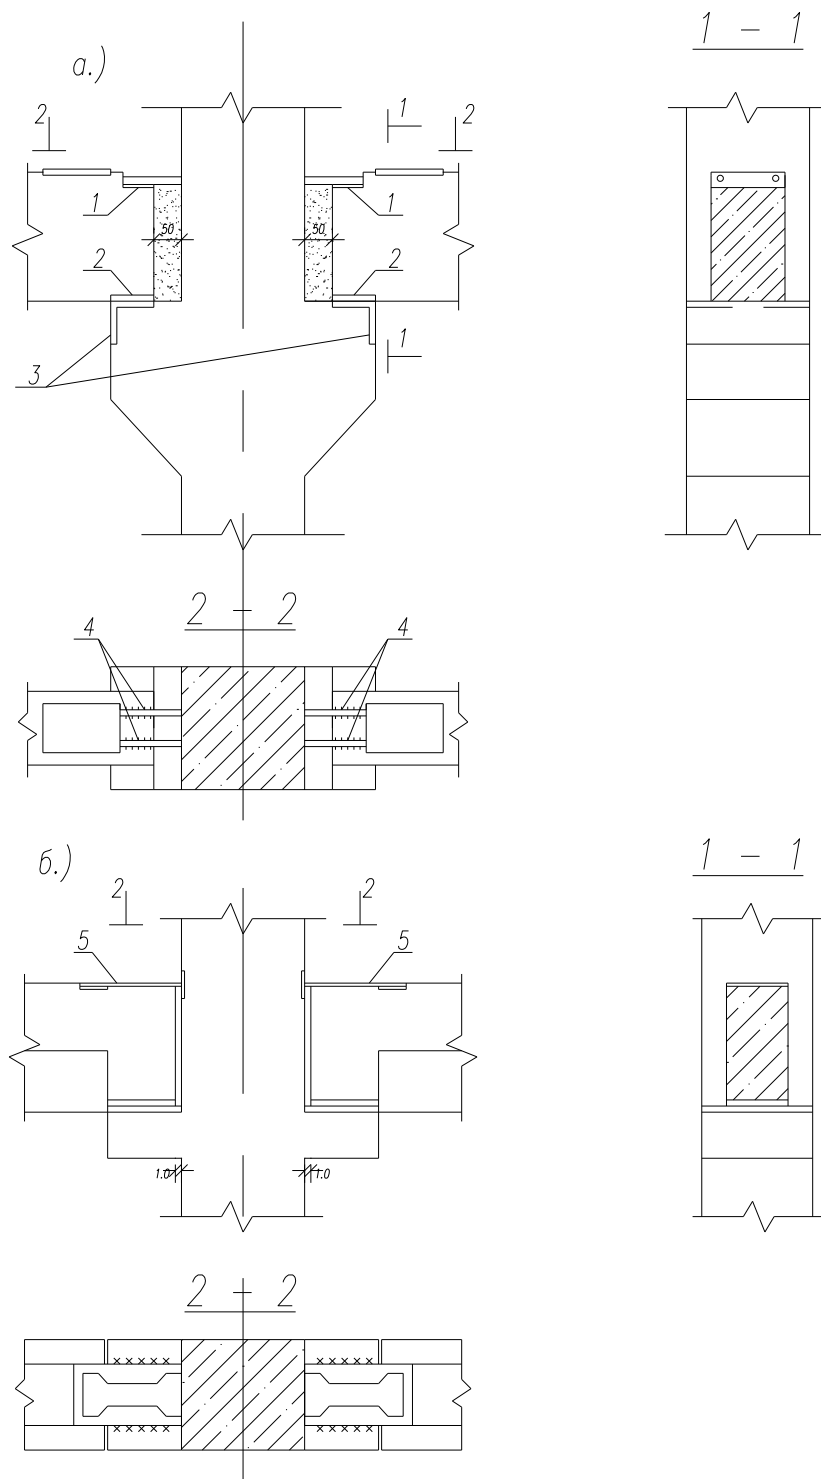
Типовые стыки ригелей с колоннами для промышленных (а) и гражданских (б) : 1,2,3,—закладные детали; 4—надопорные стыковые стержни; 5—фигурная деталь "рыбка", привариваемая на монтаже
